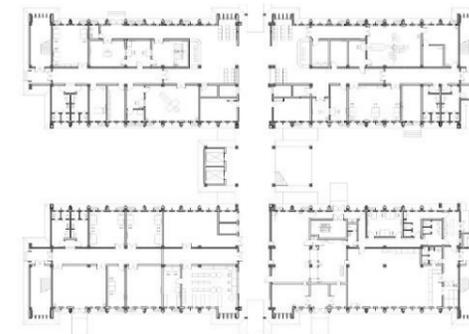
Plan au rez-de-chaussée du bâtiment de la technologie médicale, Source : Archdaily
